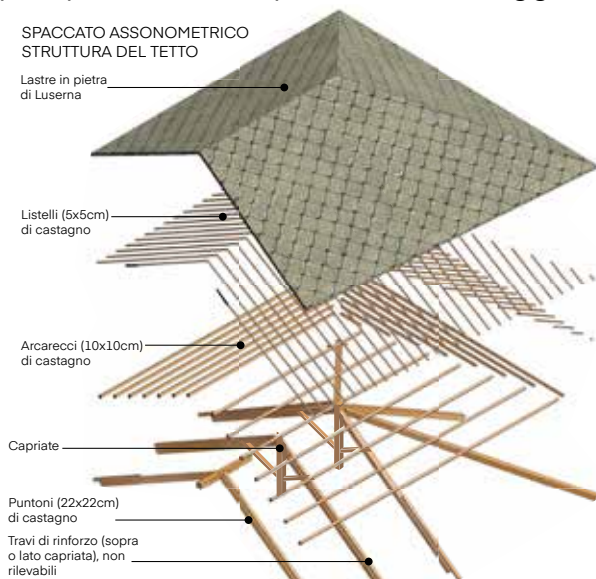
Spaccato assonometrico della struttura del tetto (tav 8).
